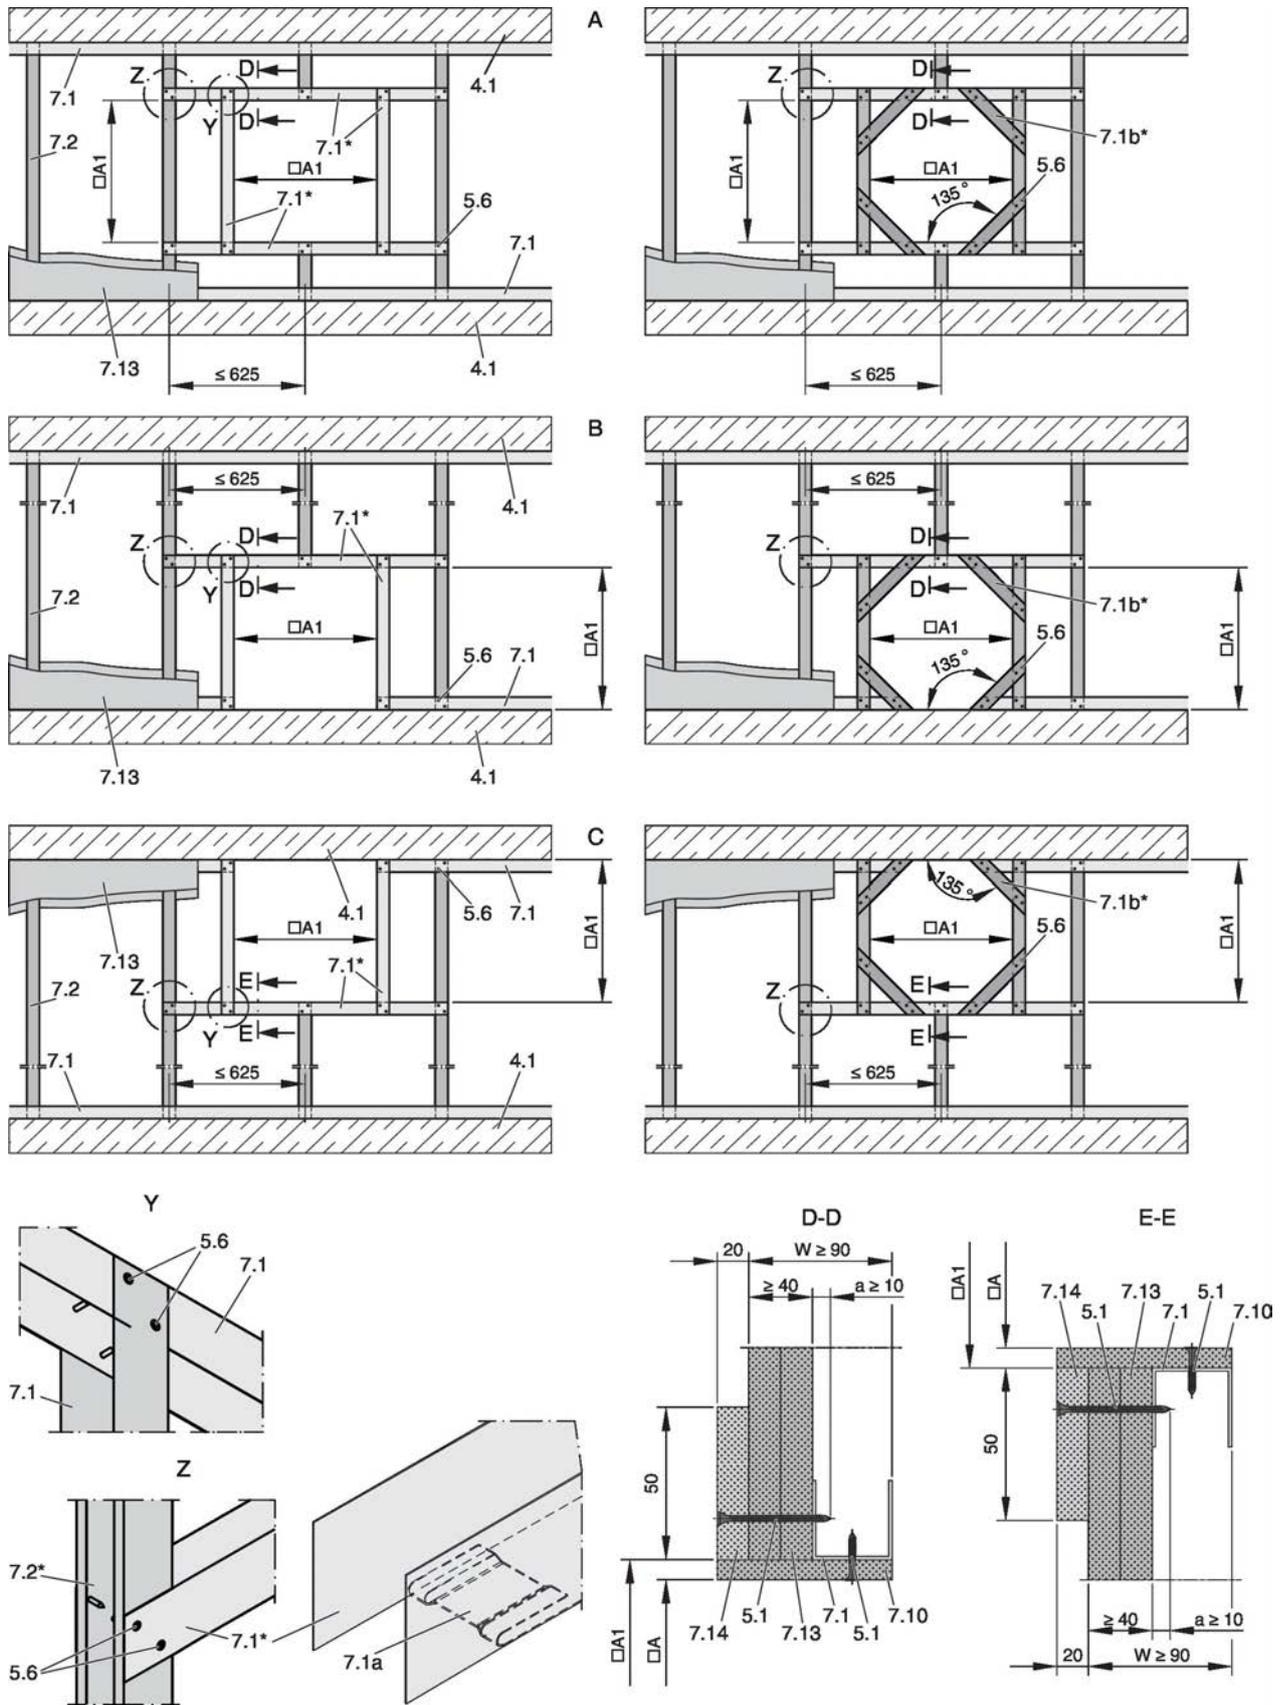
Paredes de caixa com estrutura de apoio de metal e revestimento de um lado
